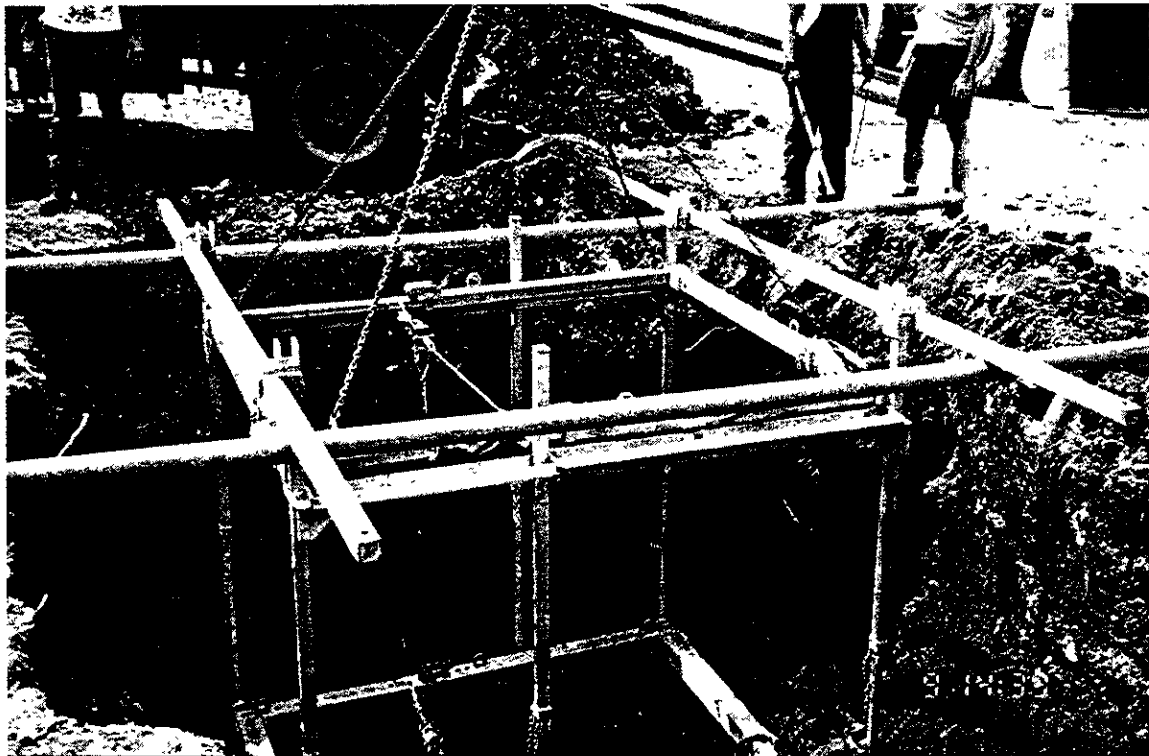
Mise en place de barres transversales pour supporter le cadre VM2
